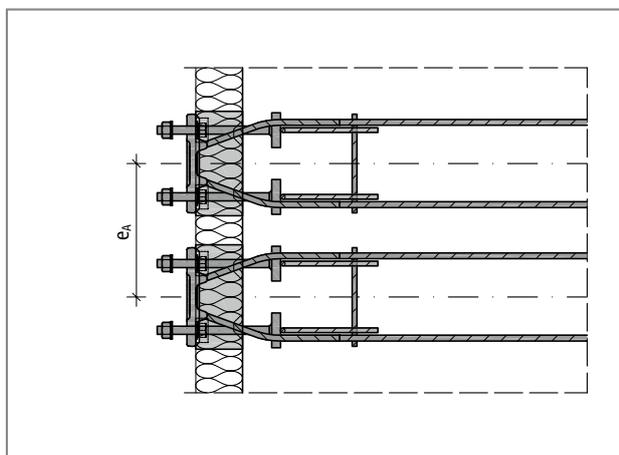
Schöck Isokorb® T type SQ : Entraxe
